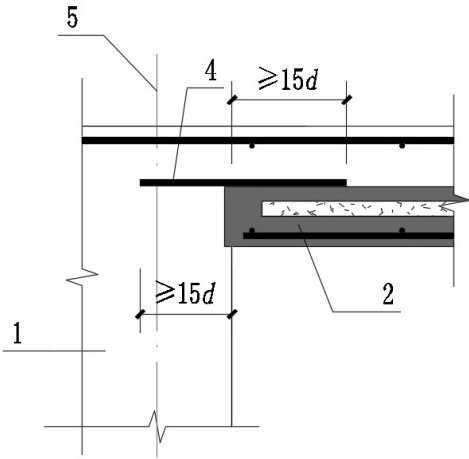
夹芯叠合楼板板侧支座处构造示意
